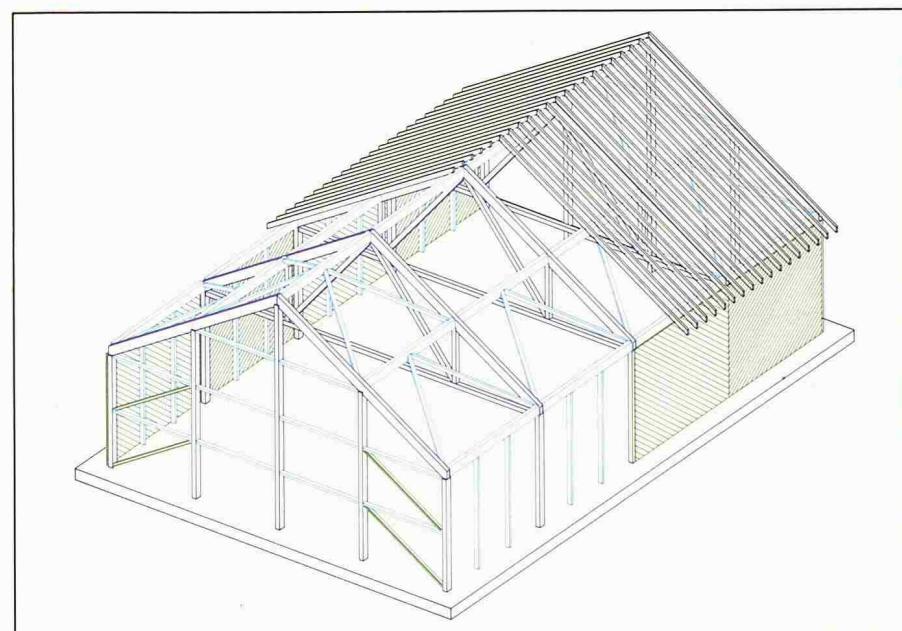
Ergebnis: In 10 Min. konstruierte Konstruktion
